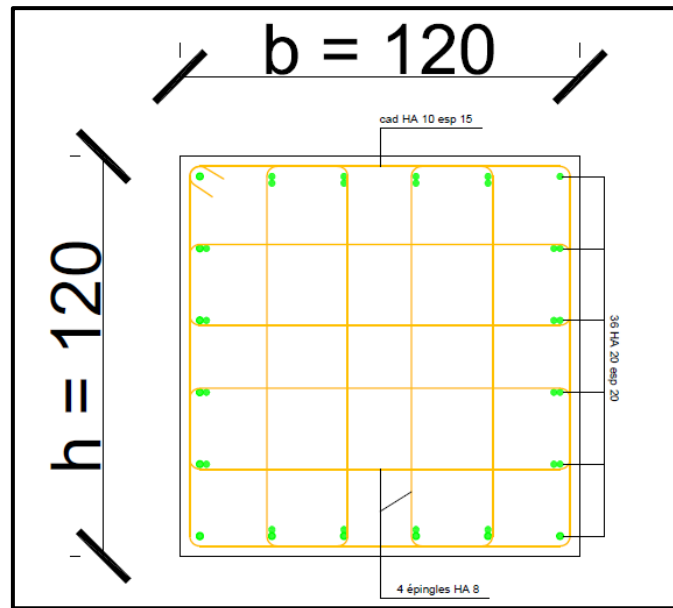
Ferrailage de la ceinture supérieure (coupe transversale)
